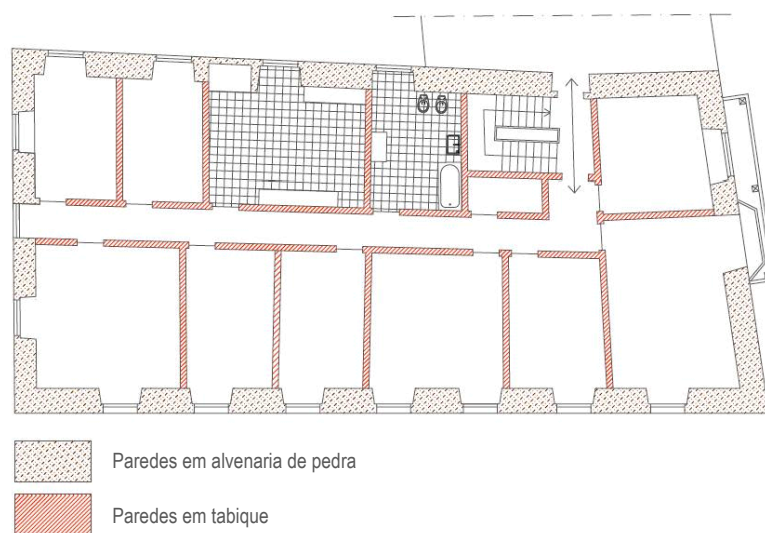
| Planta do piso estudado (piso 1, fachada Norte)
